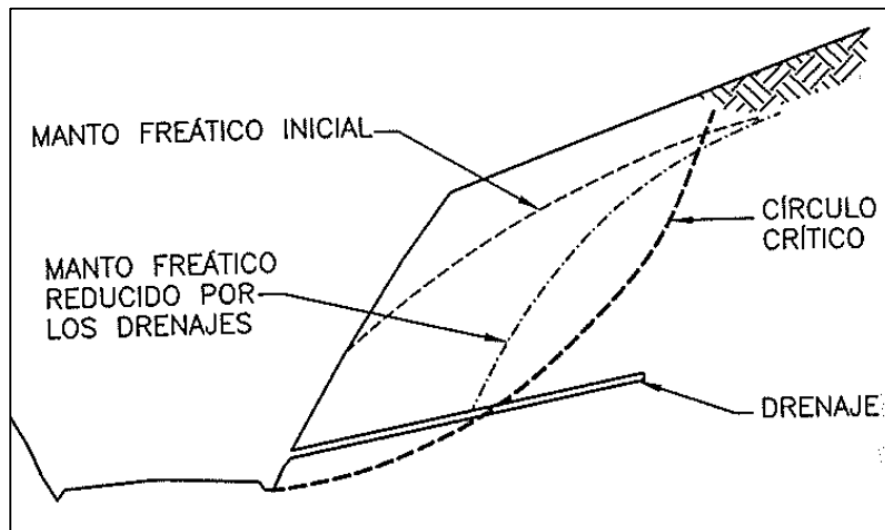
Esquema de drenaje profundo tipo dren californiano (al pie de la ladera).
